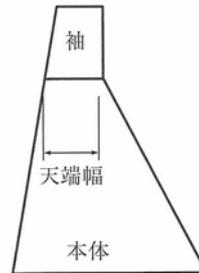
4 砂防堰堤側面図 (事例) と部位名称
